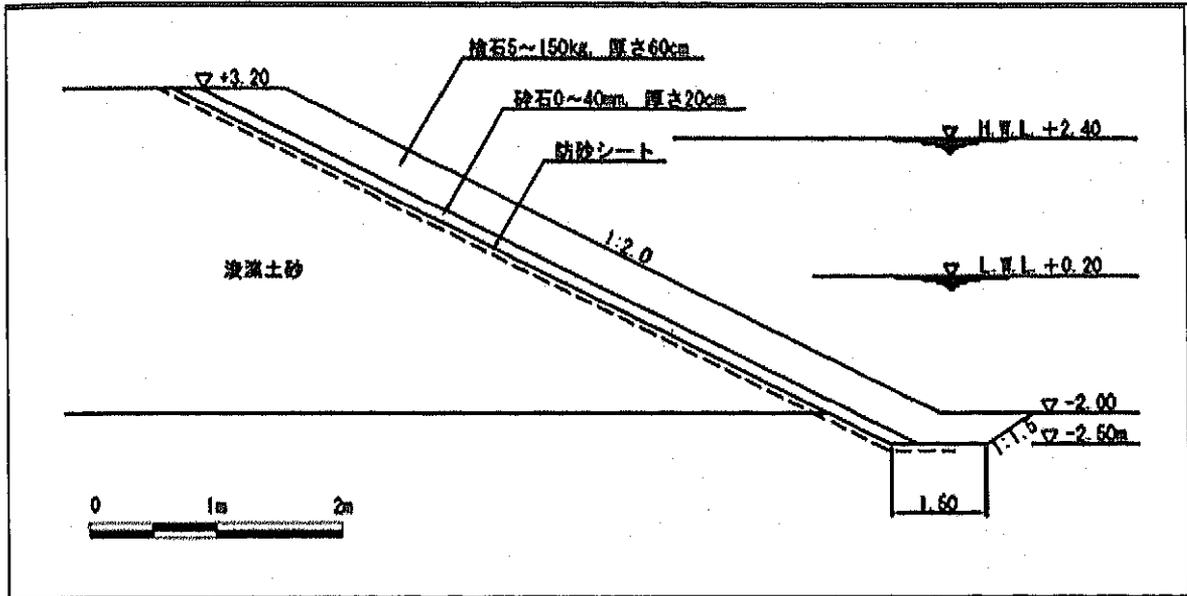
(6-1) 護岸標準断面図 (護岸A: 係留棧橋の陸側)
